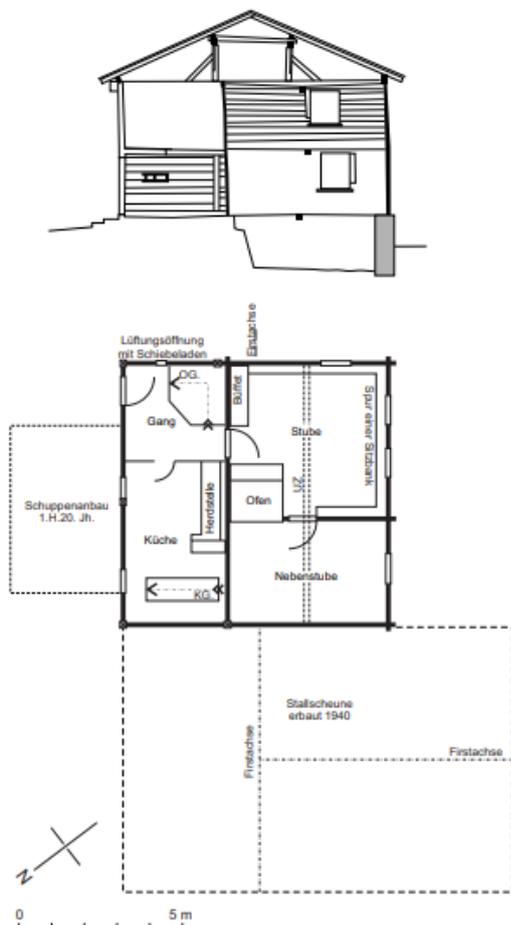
Grundriss Erdgeschoss du Querschnitt, 1:200.
